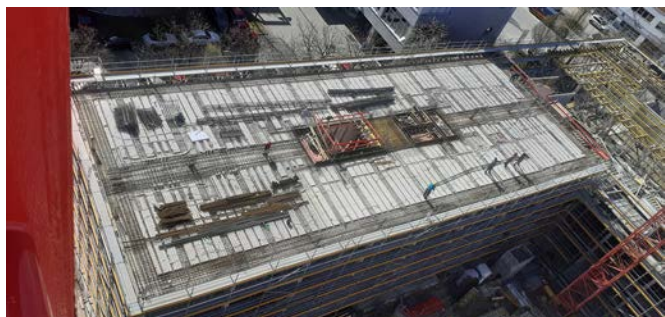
Vorgefertigte Deckenelemente für einen Grundriss
